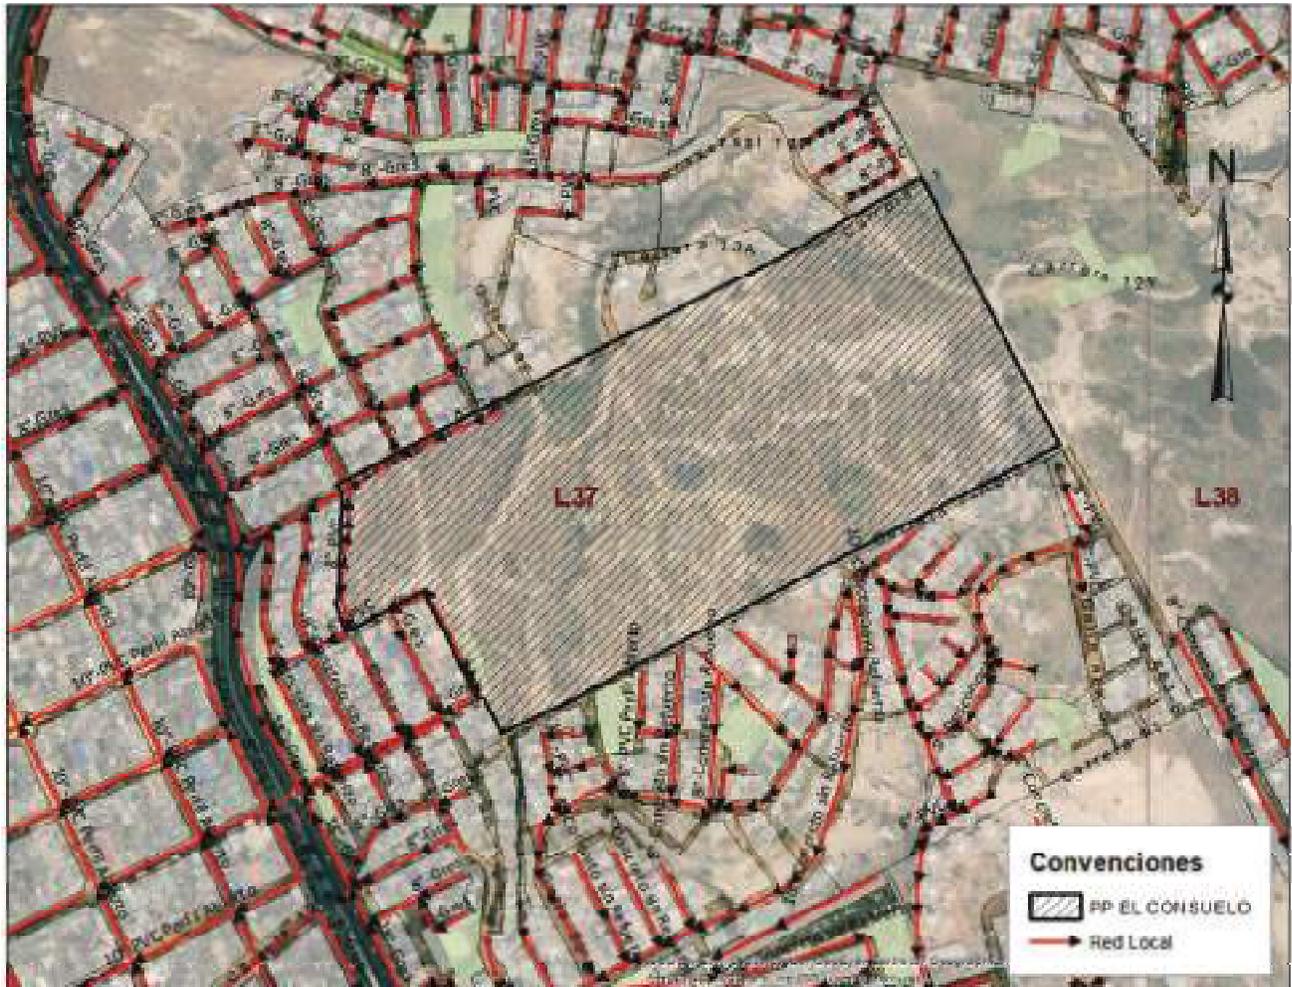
Red Troncal existente de Alcantarillado Sanitario
